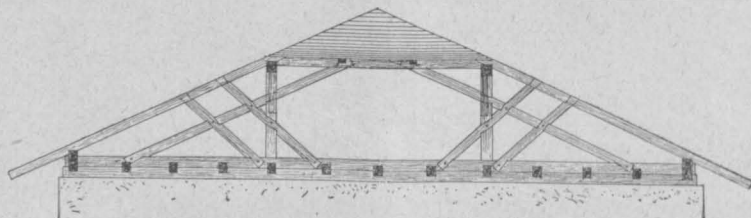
Dachgiebel von einem Bauernhause bei Waidbruck (Tirol)
